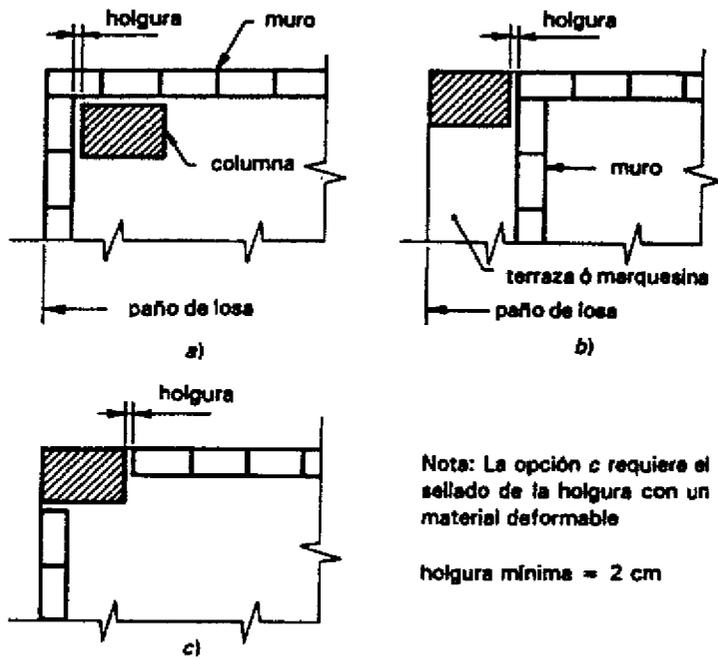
Posibles disposiciones de muros en planta para desligarlos de la estructura (Ref. 5)
